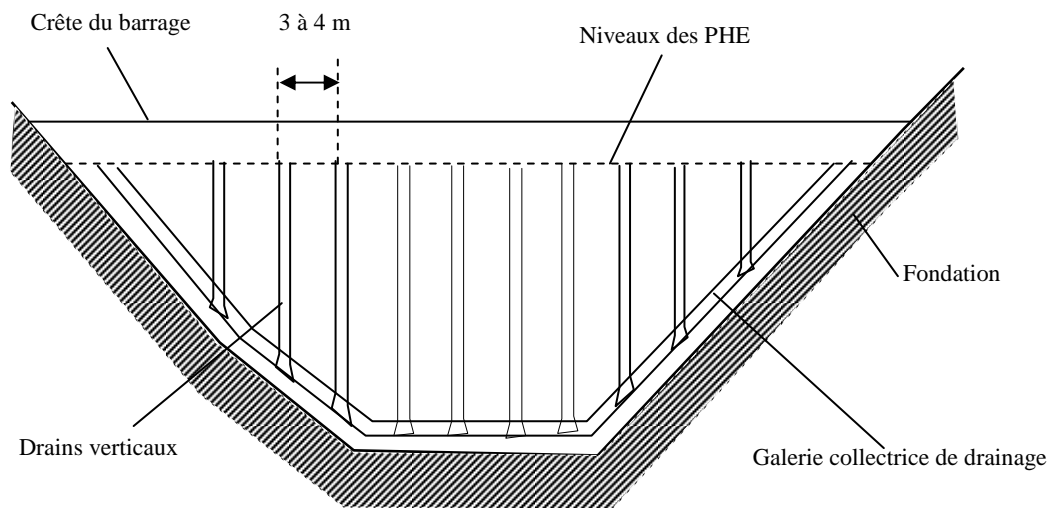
Coupe l'longitudinale du barrage indiquant le réseau de drainage vertical
